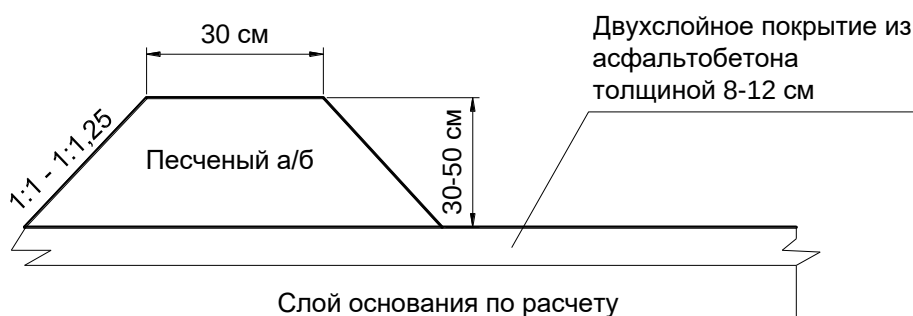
Обваловка открытой площадки для хранения сыпучих бестарных химических и комбинированных ПГМ
